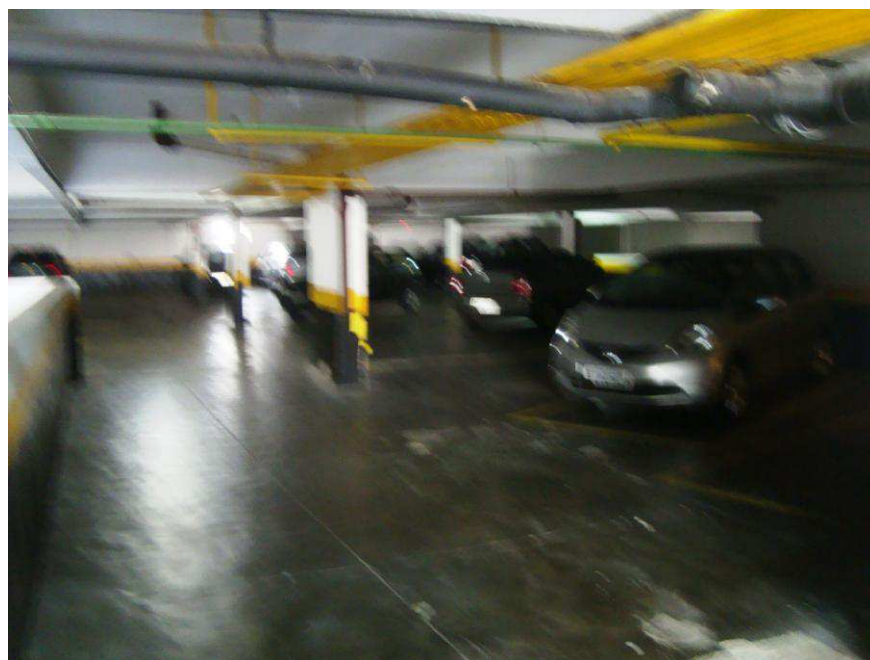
Vista parcial de um dos pavimentos de estacionamento
